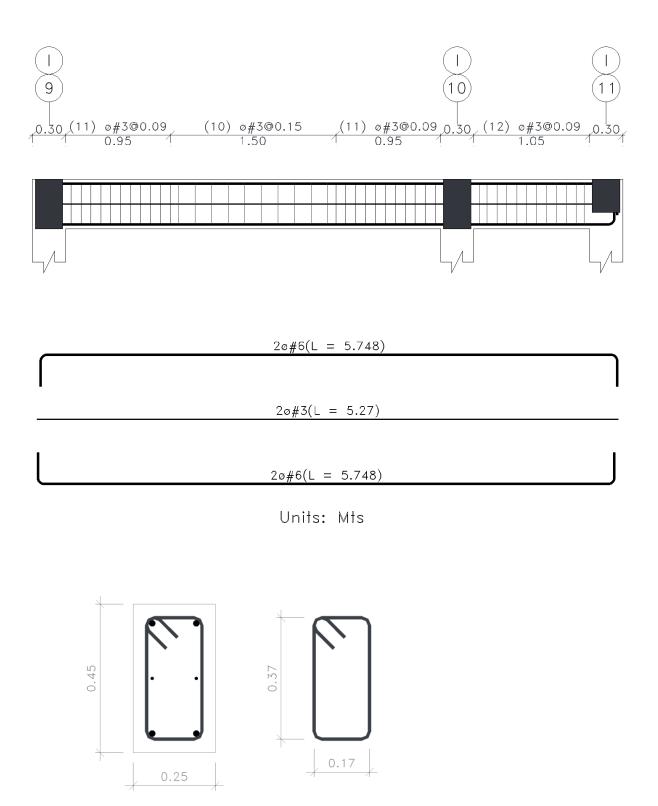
Detalle estructural de la viga para la vivienda residencial vis multifamiliar 12D.
